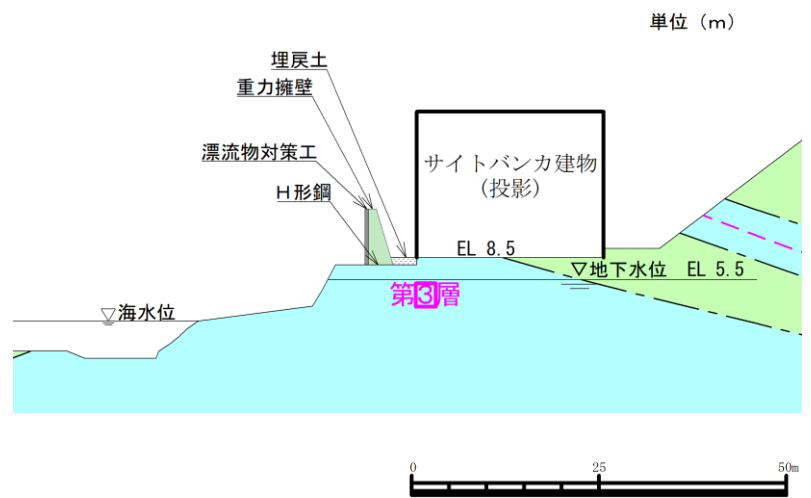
防波壁 (波返重力擁壁) の横断面図 (⑤-⑤断面)
